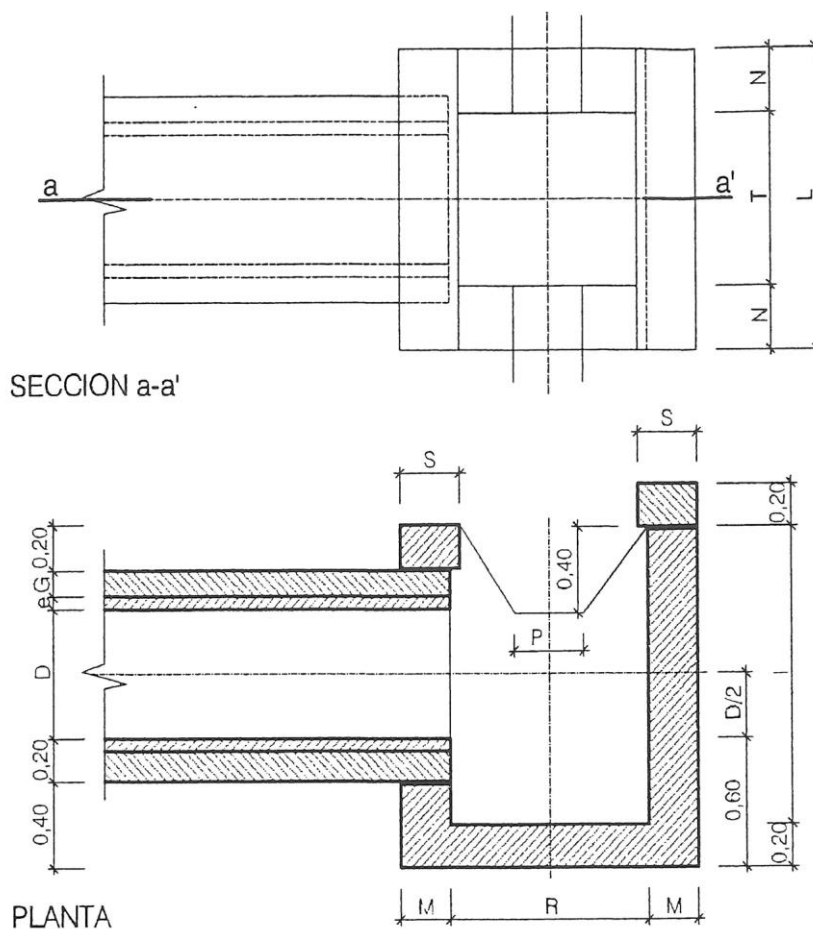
Arqueta tipo. Fuente: Elaboración propia.
